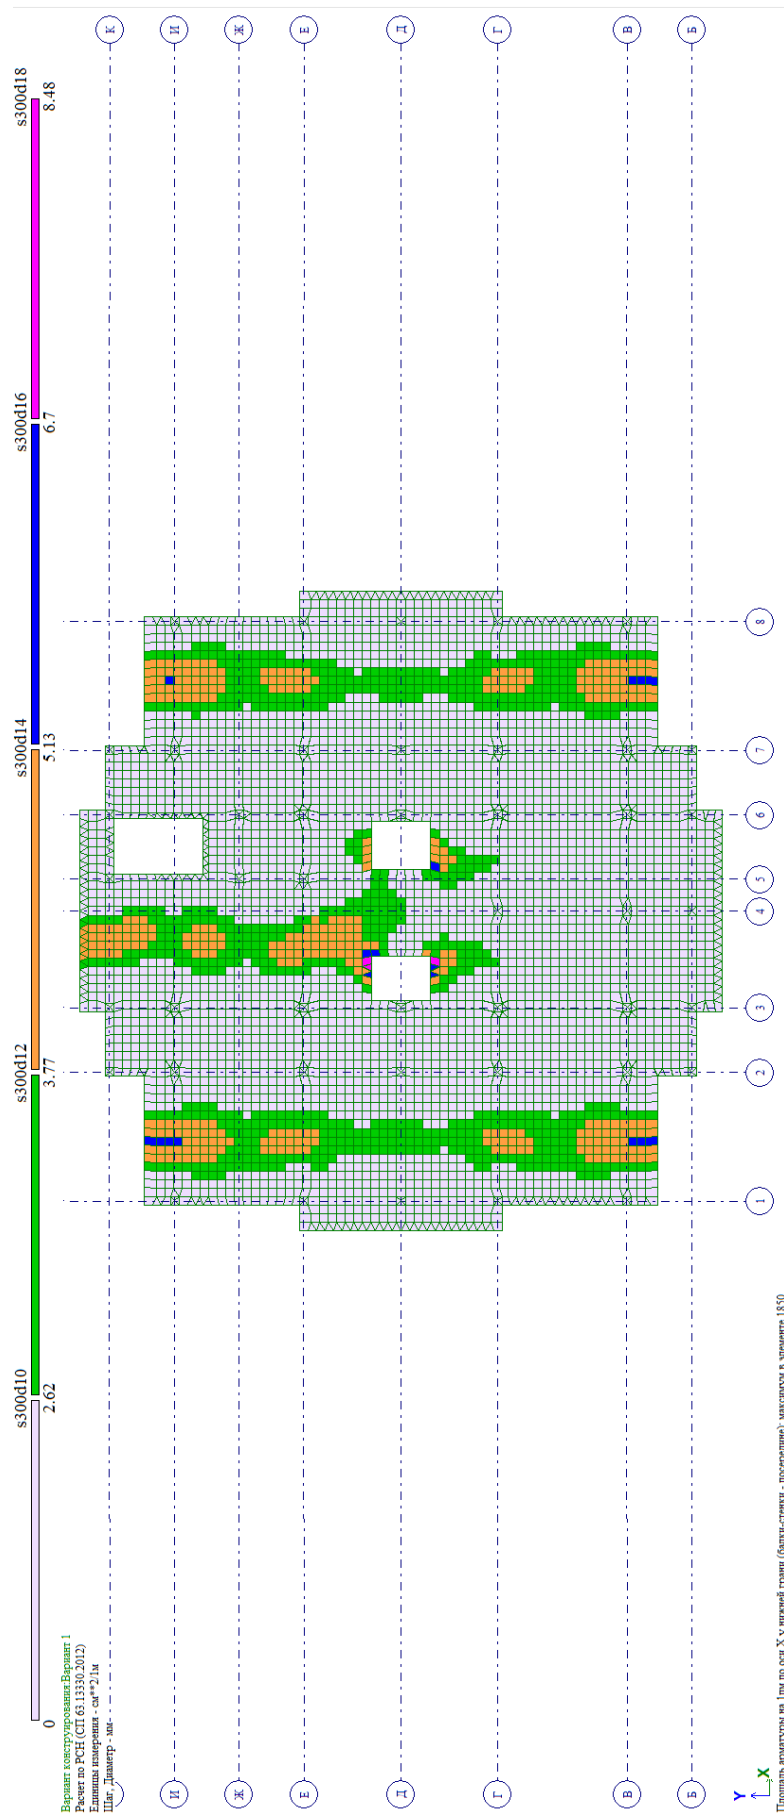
Схема подбора нижней арматуры вдоль буквенных осей (см²)
